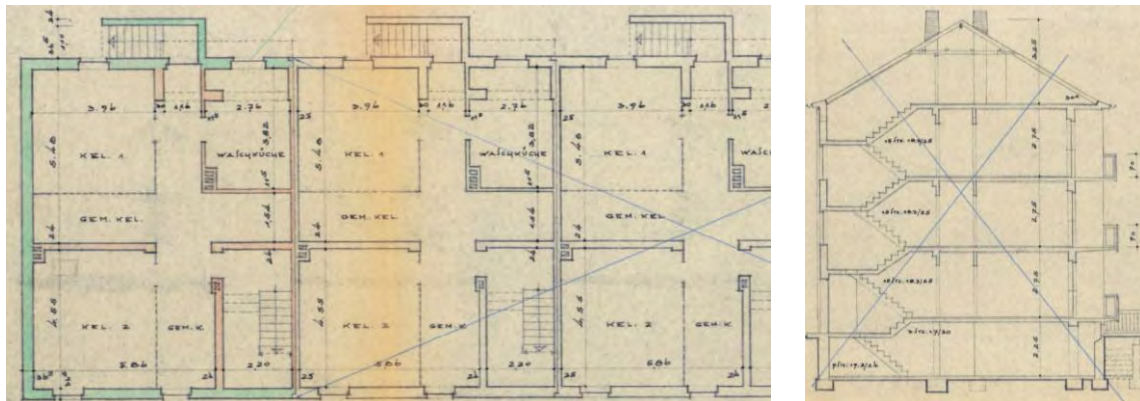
Kellergrundriss und Schnitt. Gebäudepläne aus der Bauzeit
